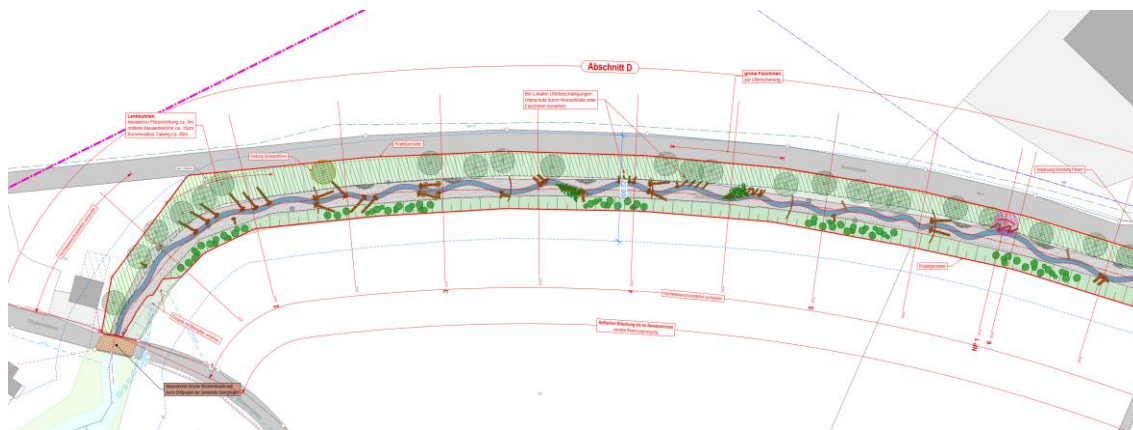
Ausschnitt Situationsplan Massnahmen Abschnitt D (Plan 215)
